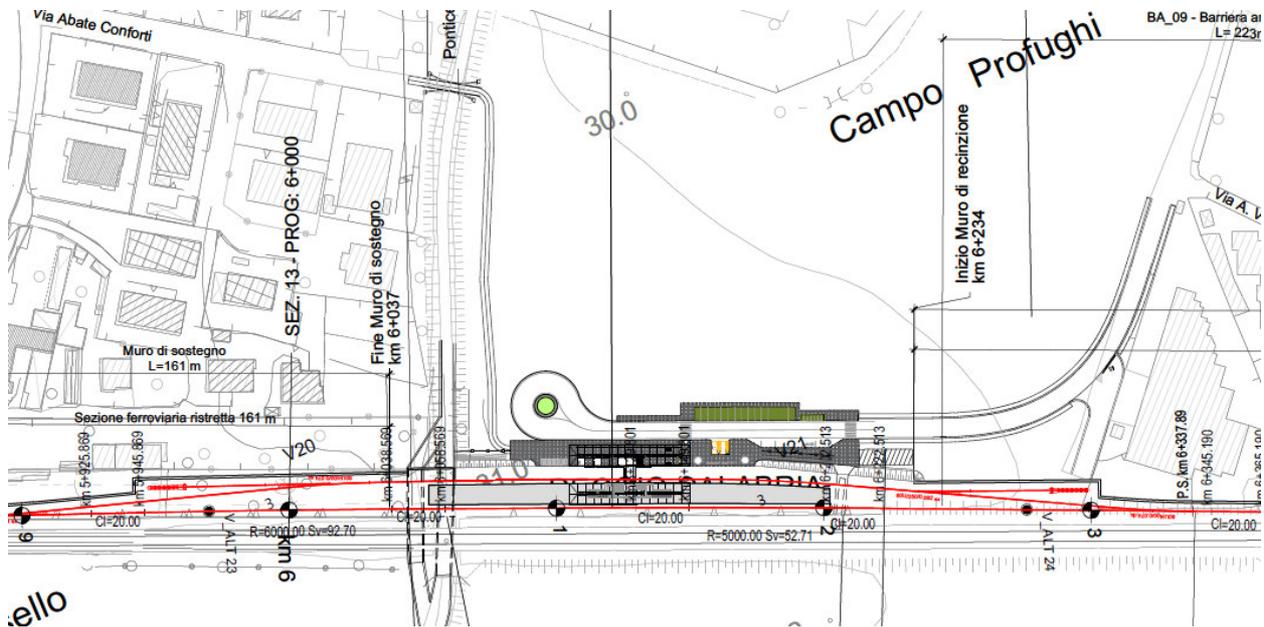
Stralcio planimetria su cartografia – Fermata S. Antonio
